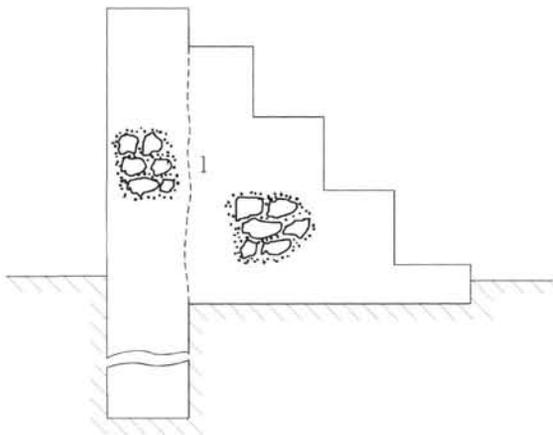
Petit barrage en maçonnerie à parement aval en gradins.
